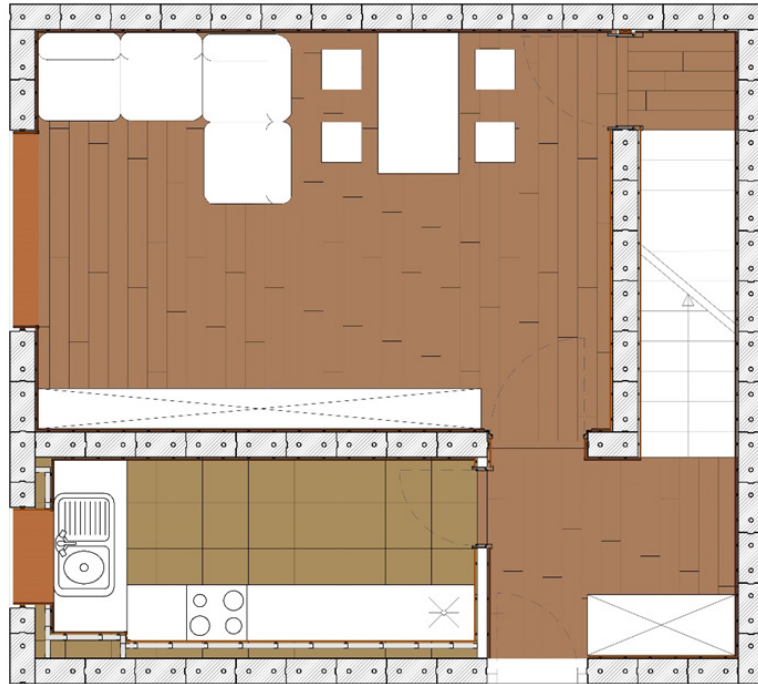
Grundriss-EG-Versuchsbau- Möblierung
